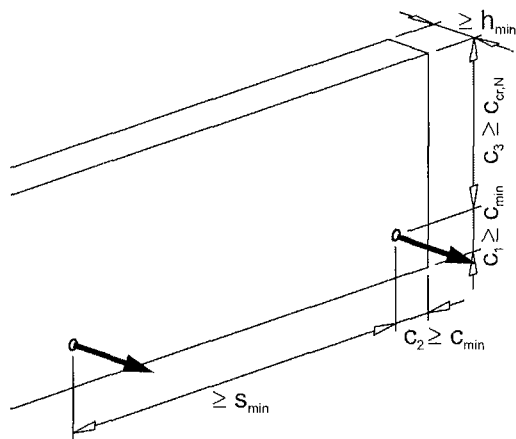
Einbausituation Wandfläche - Zugbeanspruchung, ohne Rückhängebewehrung
